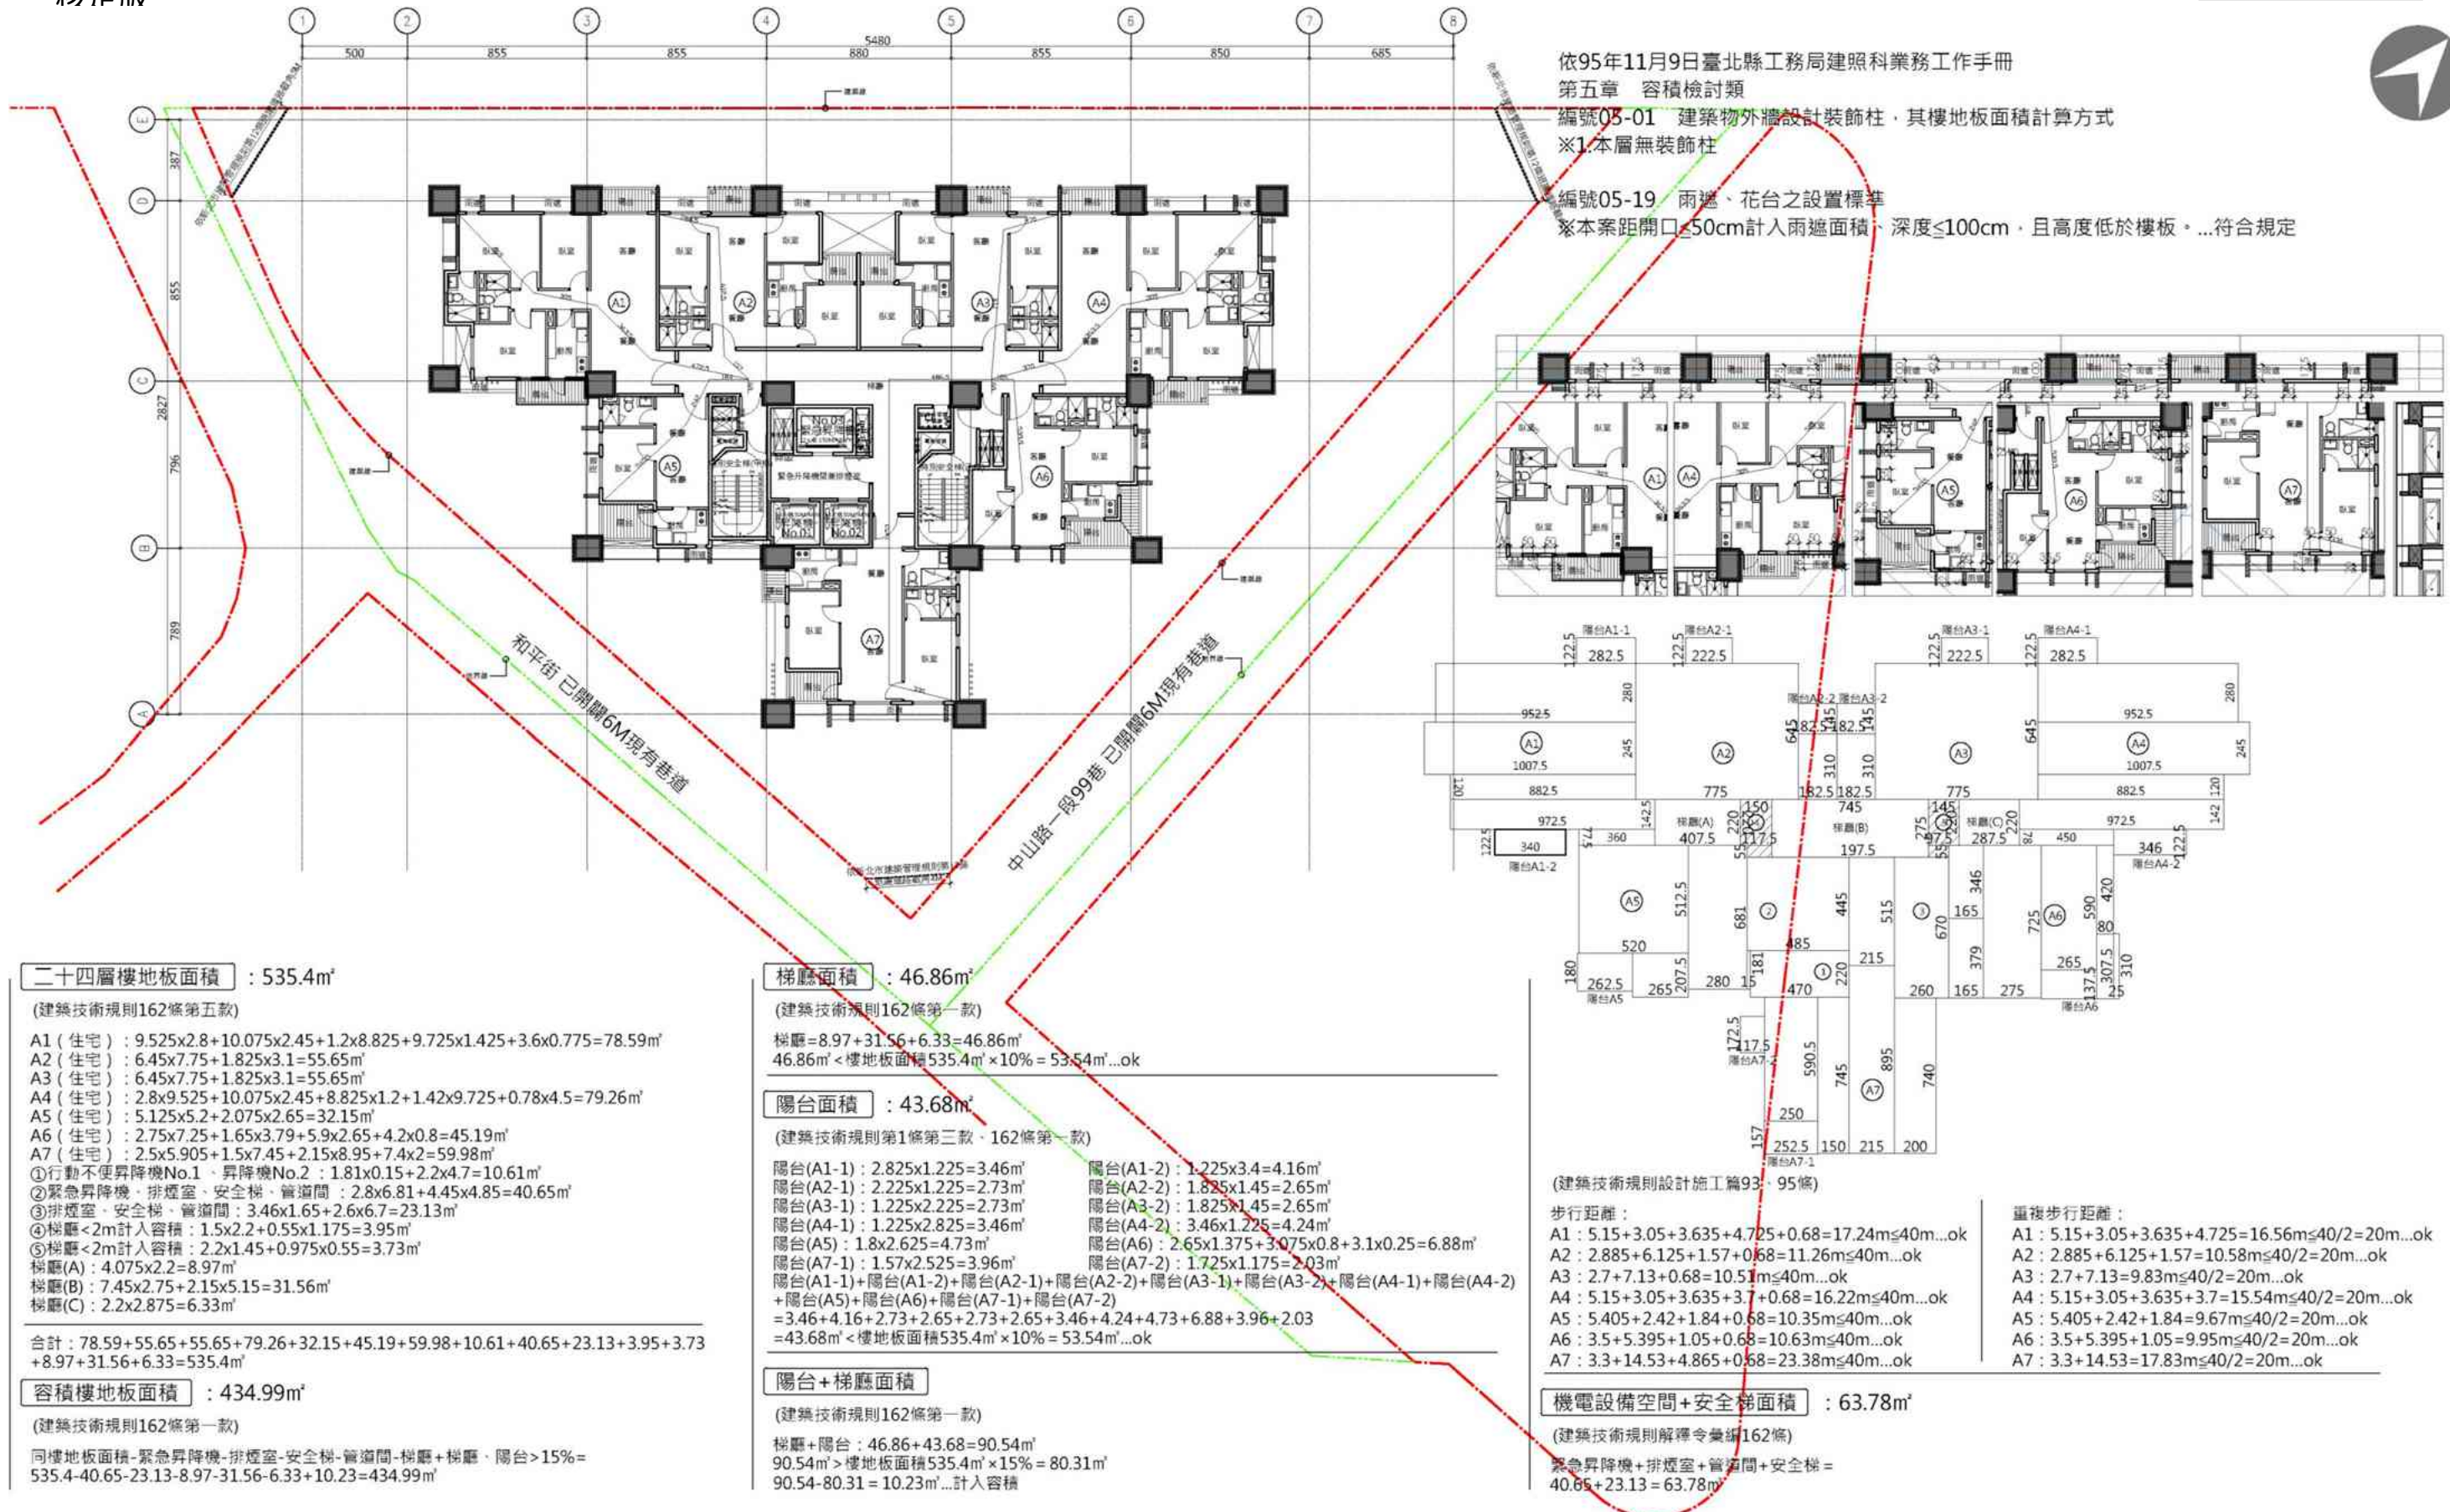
24F 平面圖 ; SCALE A3=1/300
